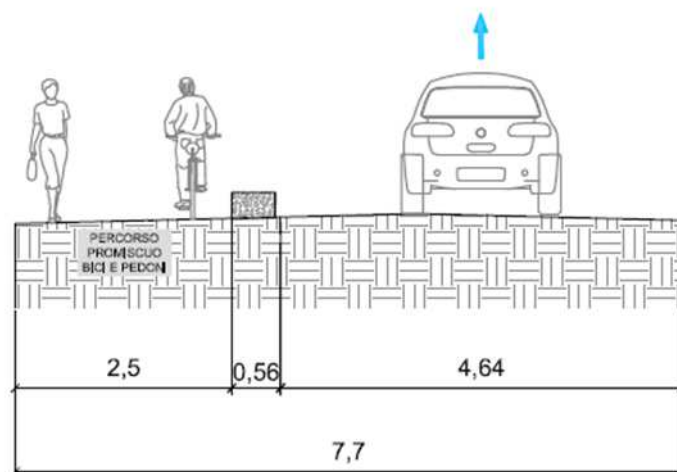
Sezione tipo Lungarno Sette Fratelli Cervi – stato di progetto
